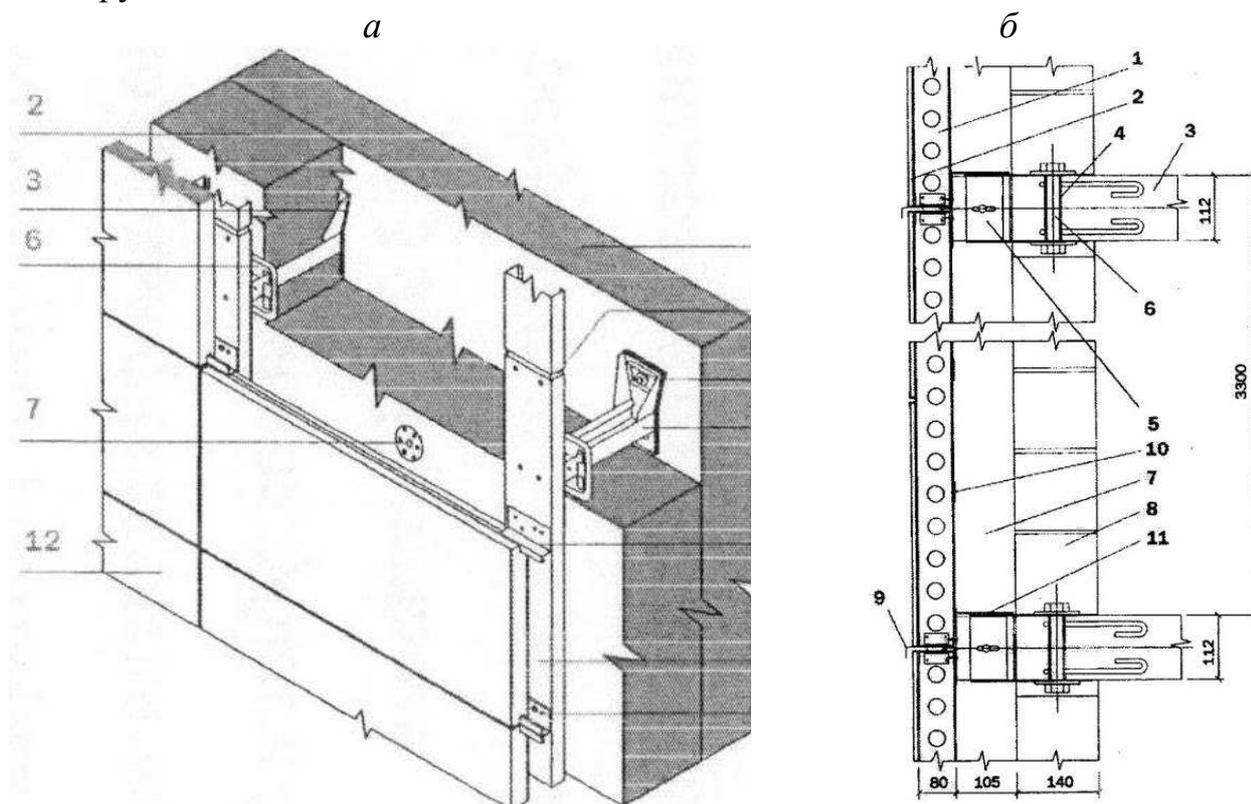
Принципиальные схемы фасадных систем высотных зданий:
